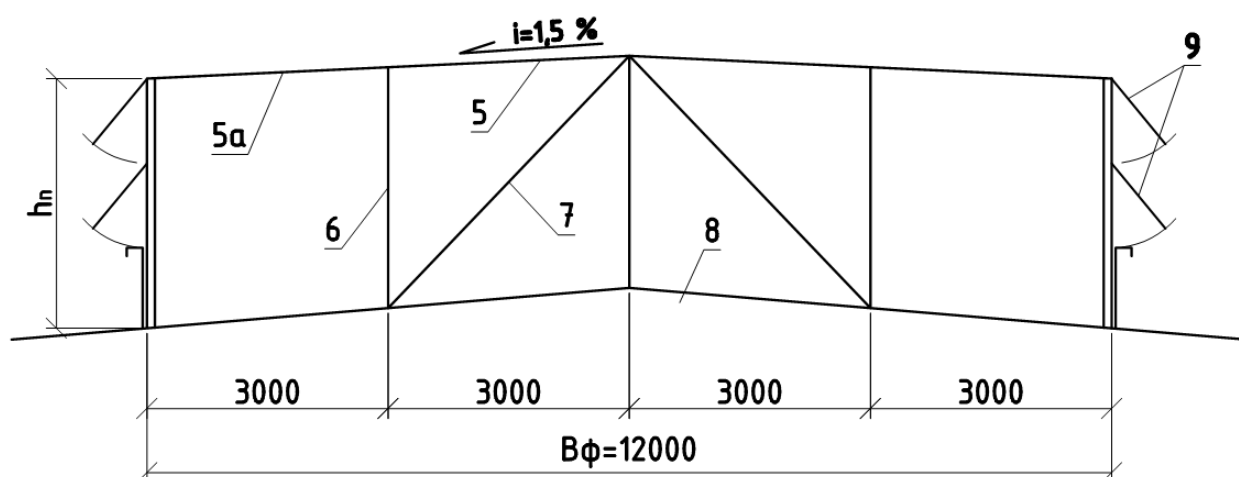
Поперечная рама фонаря: 5 - ригель из двух уголков; 5а - ригель из двух швеллеров; 6 - стойка из двух уголков; 7 - раскос из двух уголков; 8 - верх несущей конструкции покрытия; 9 - остекленные переплеты фонаря.
